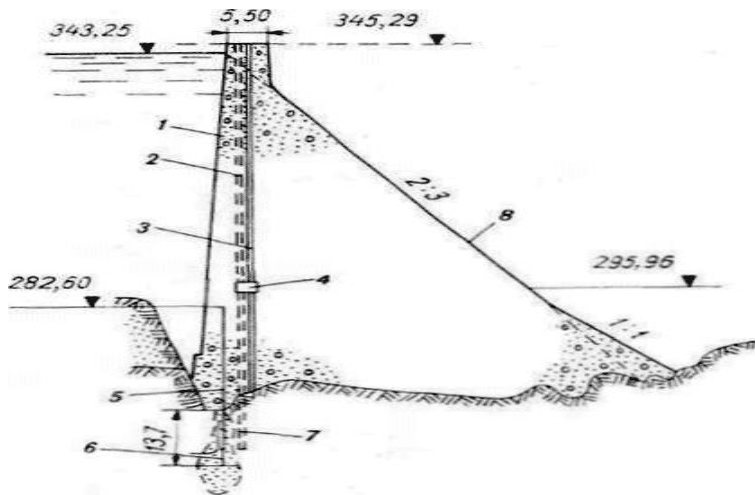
Поперечный профиль глухой бетонной плотины большого напора.
